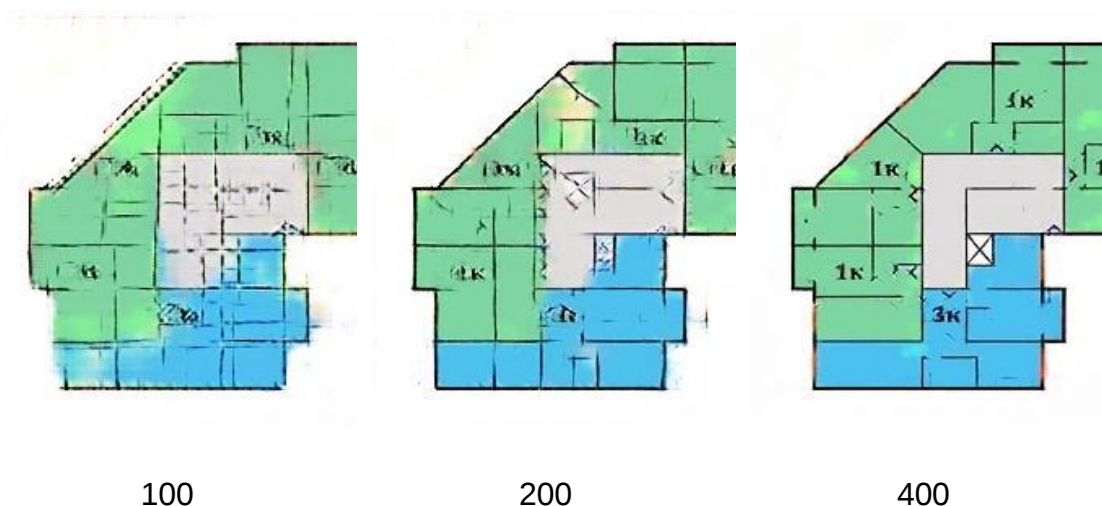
Plano de planta 1 con épocas 100, 200 y 400. Elaboración propia
